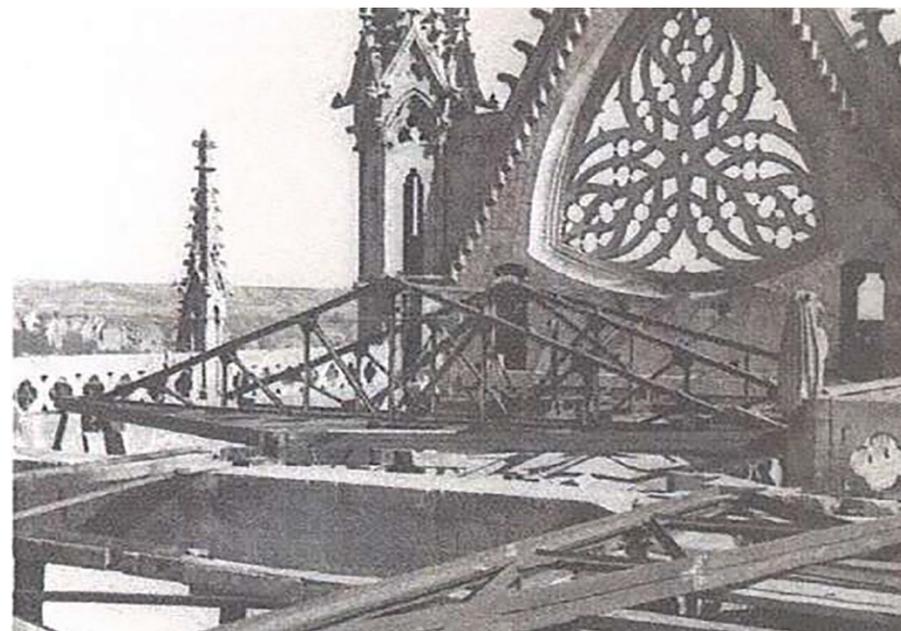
Vista de la nueva estructura metálica de la Catedral de León (Fuente: Arroyo, 2020)
